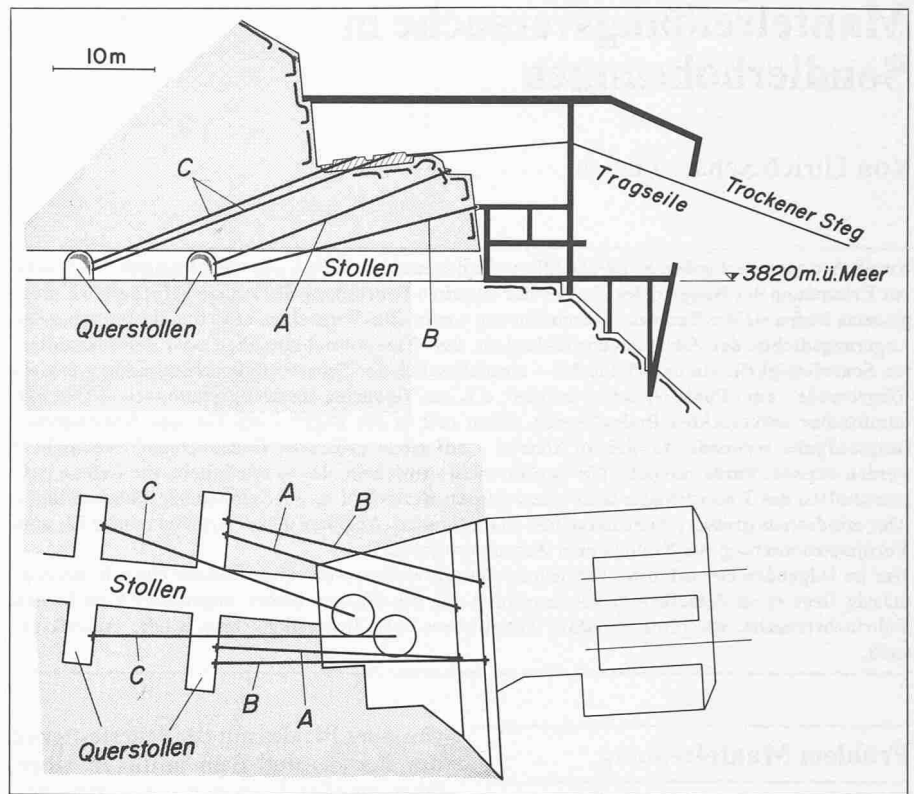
Bergstation, Verankerungen. Aufriss (oben), Grundriss (unten)
